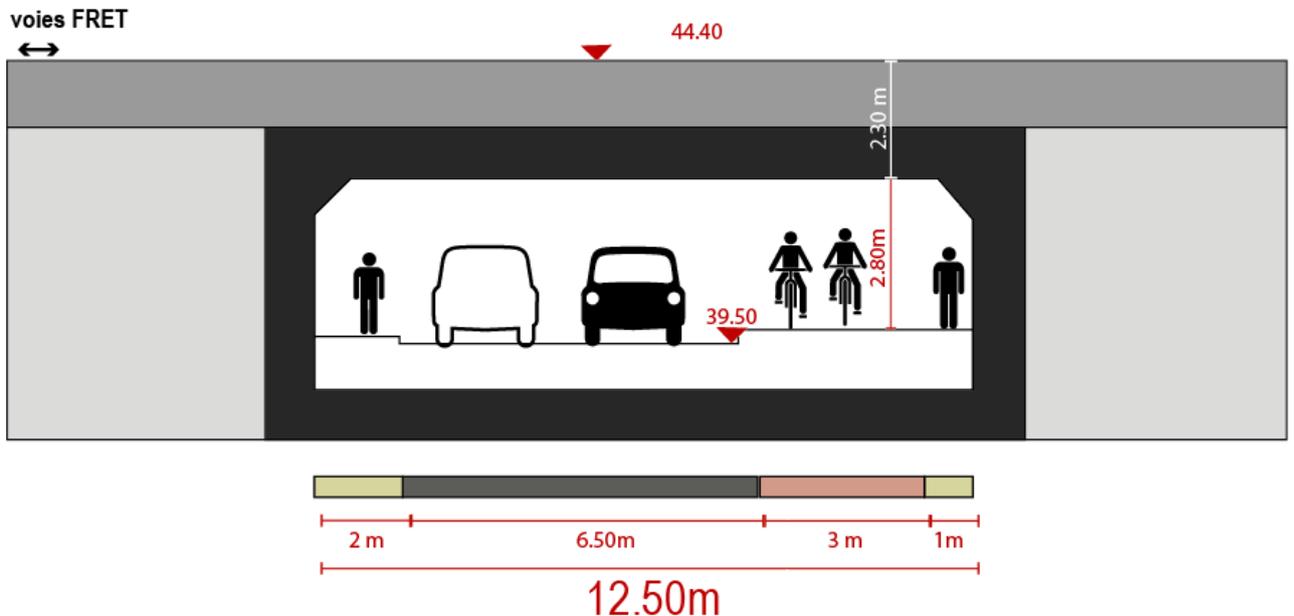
Coupe de principe de l'ouvrage cadre (source : Egis)
